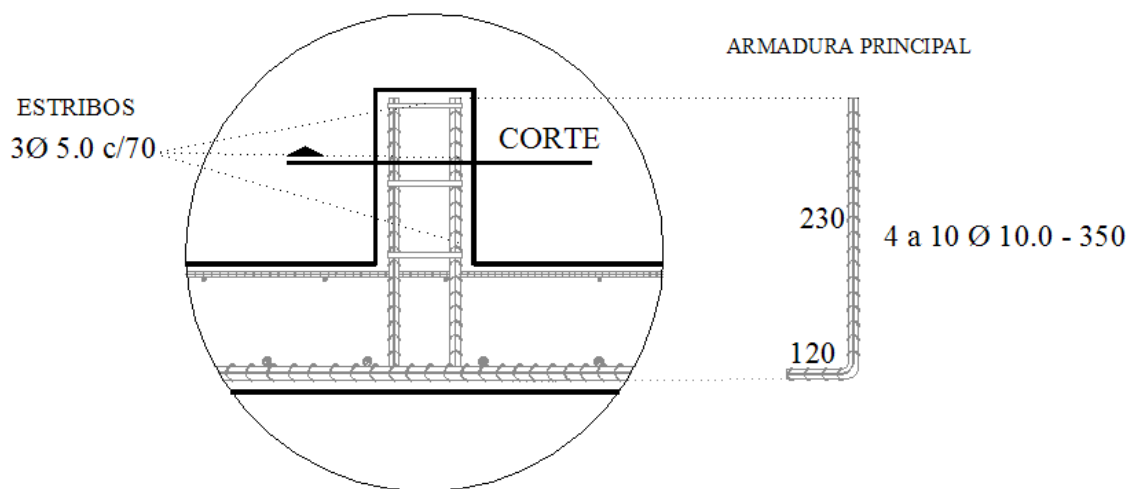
Armadura utilizada nos pilares (dimensões em mm)
